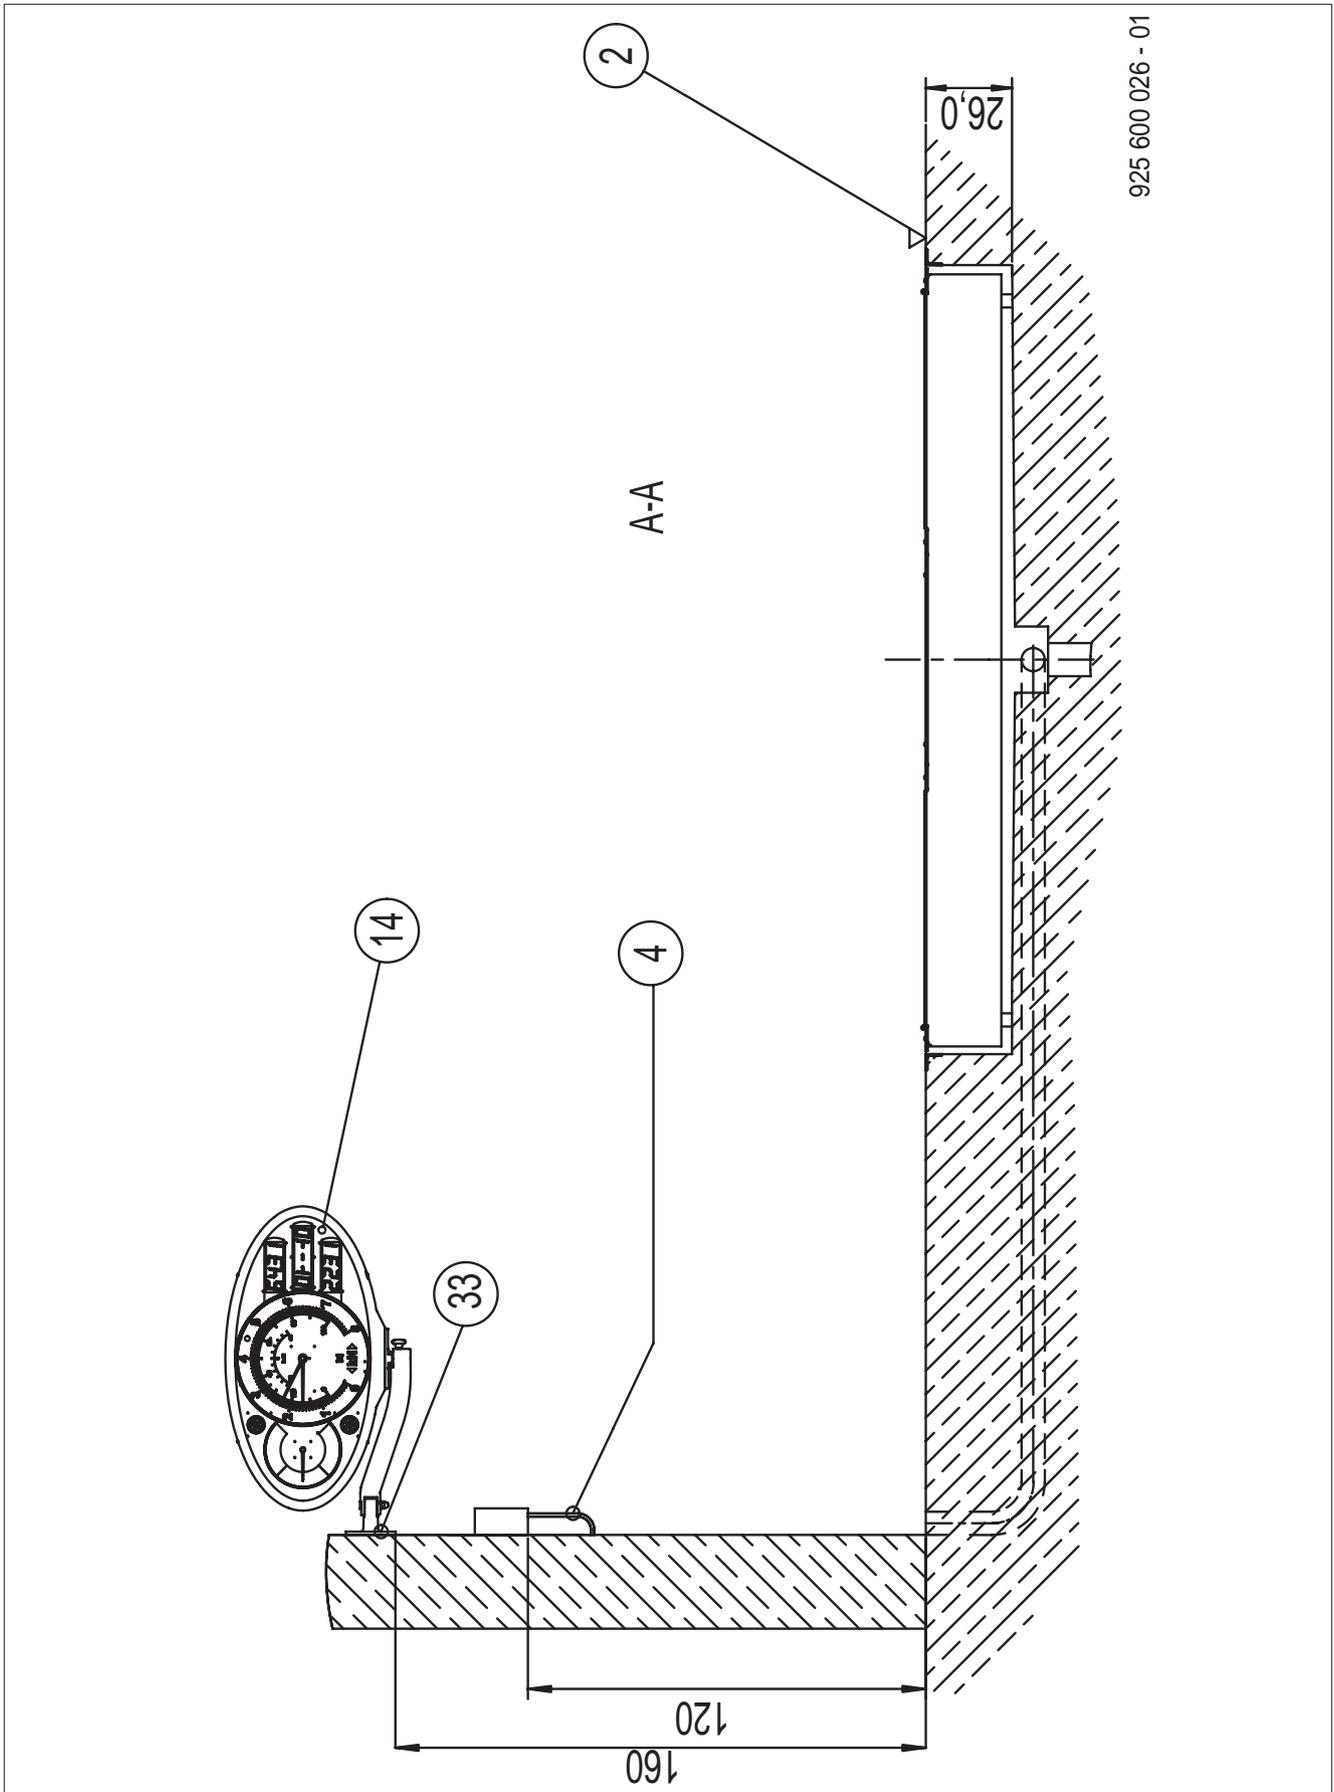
Installationsplan BD 6xx mit Wandhalterung - Schnitt A-A
